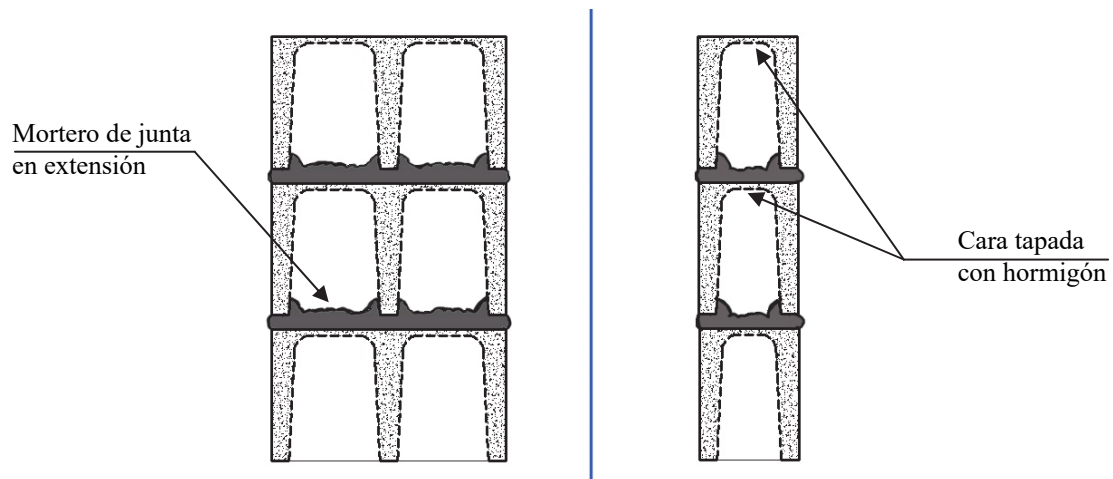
Corte longitudinal-transversal. Albañilería elaborada con bloque nortino.
